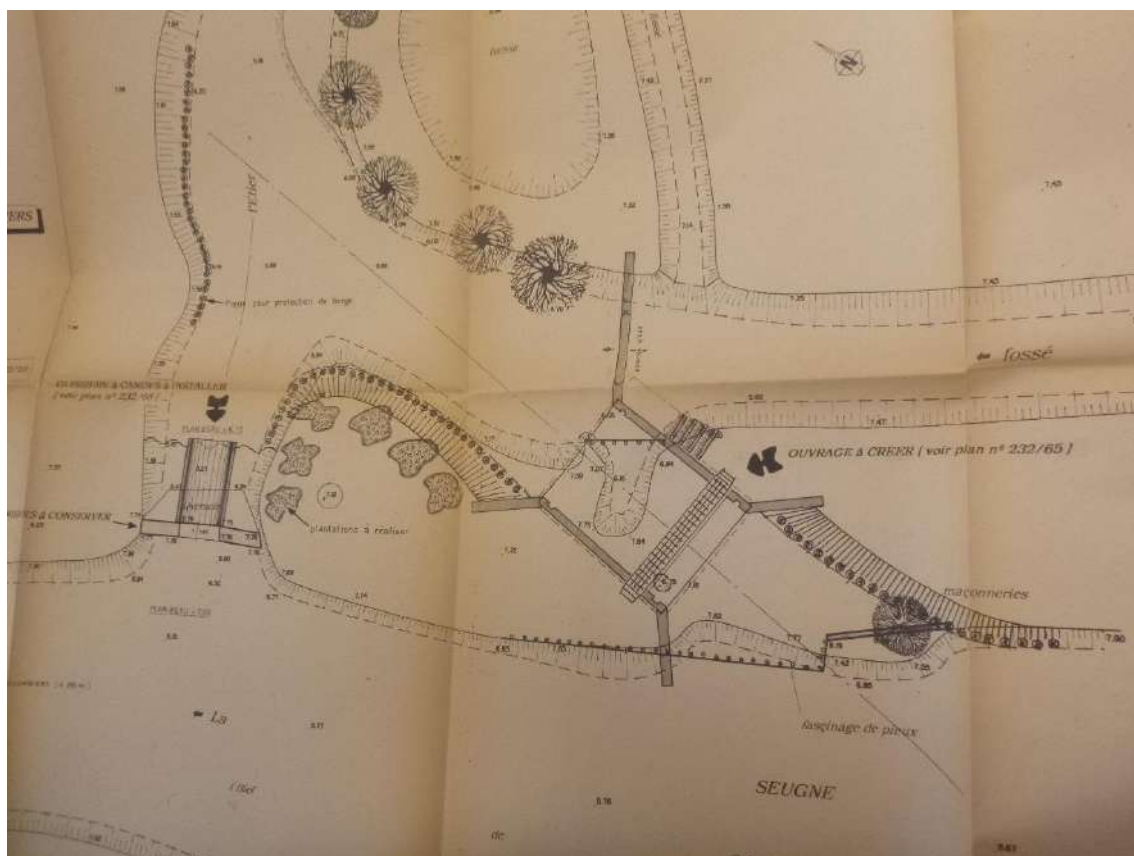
Vue en plan des ouvrages envisagés en amont du Moulin de Colombiers (UNIMA)
